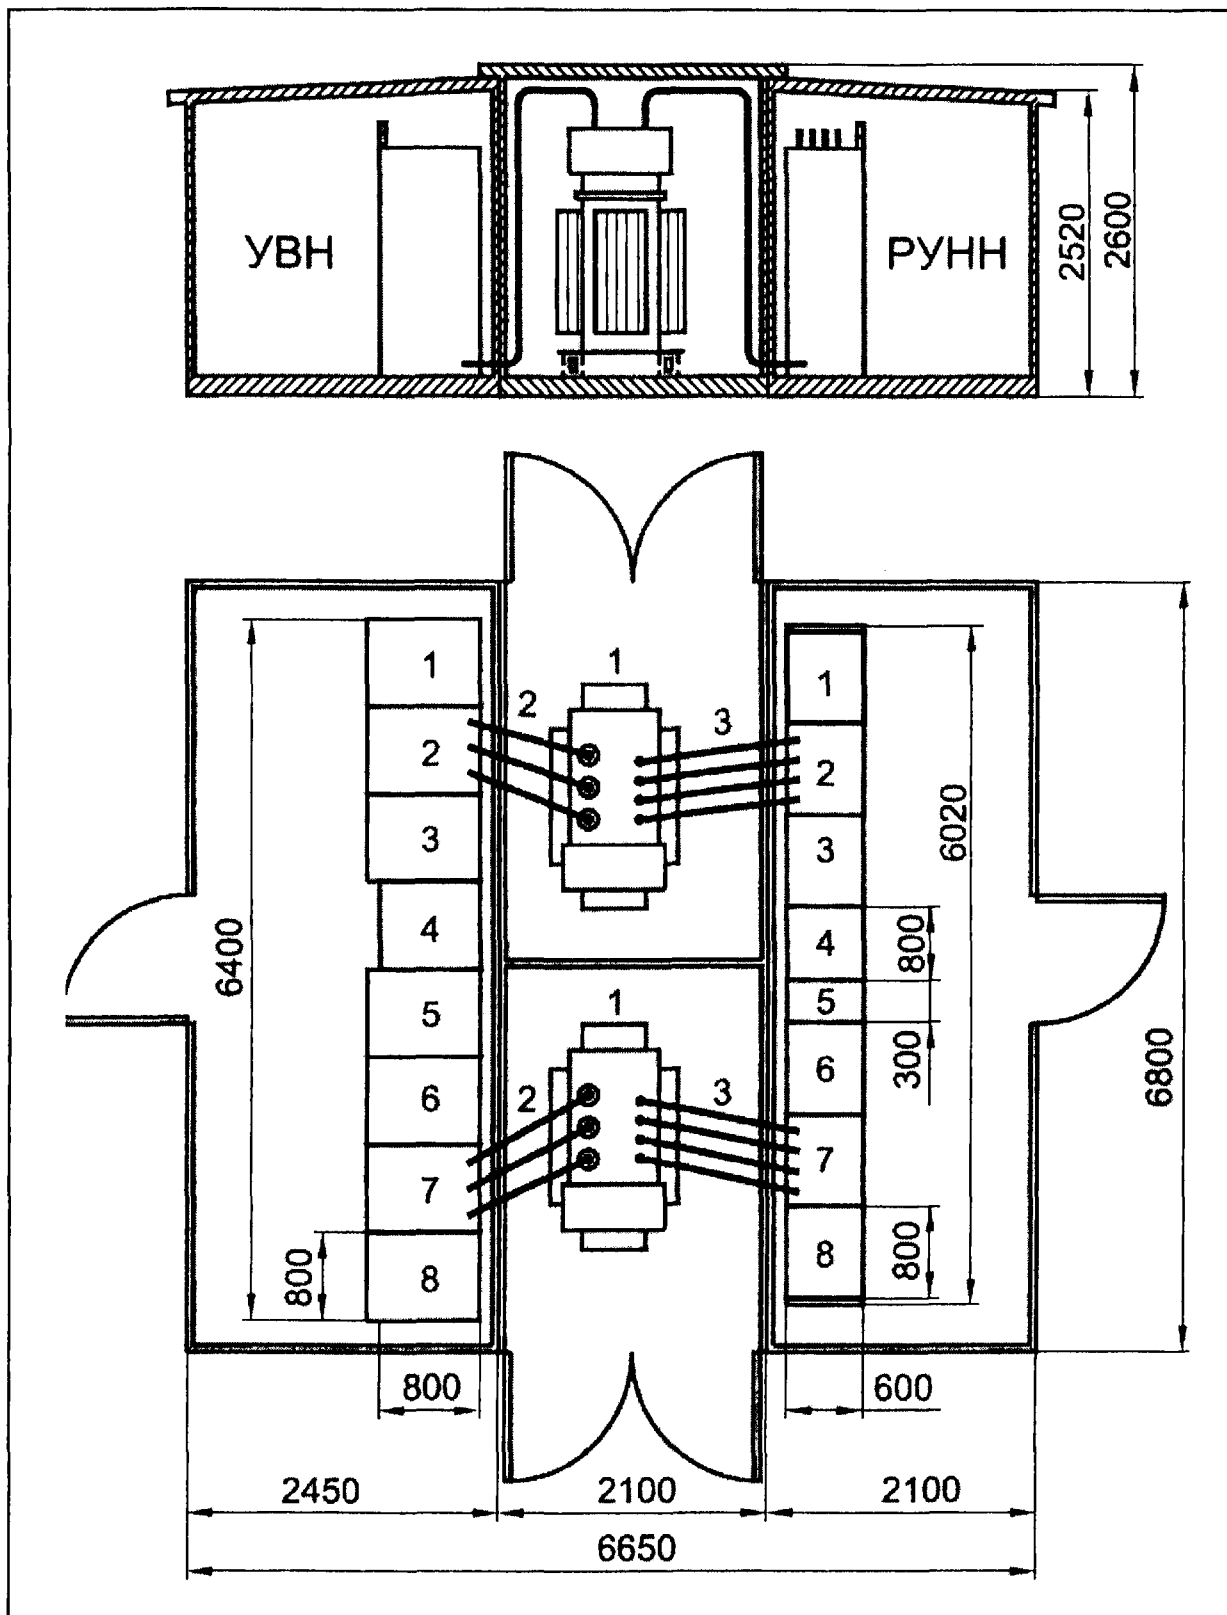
Внешний вид, компоновка и габаритные размеры
